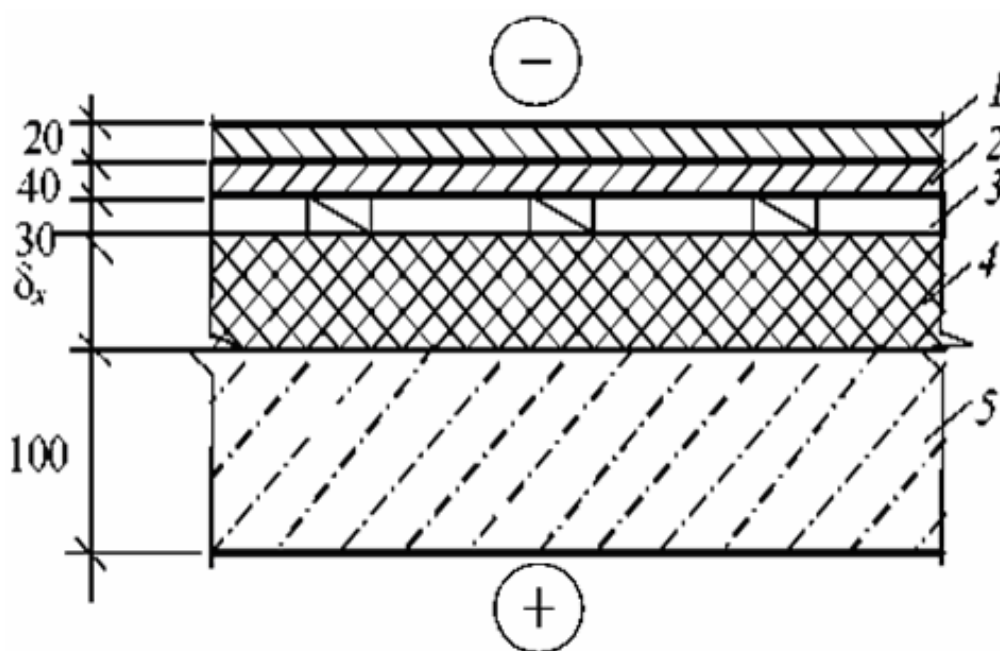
Вариант 2-й конструкции перекрытия над неотапливаемым подвалом:
